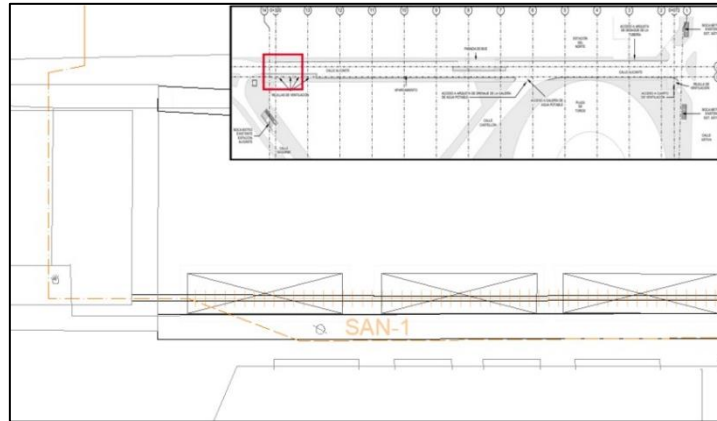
Plano de desvío SAN-SAN1-SR-SC-F3. Zona inicial
